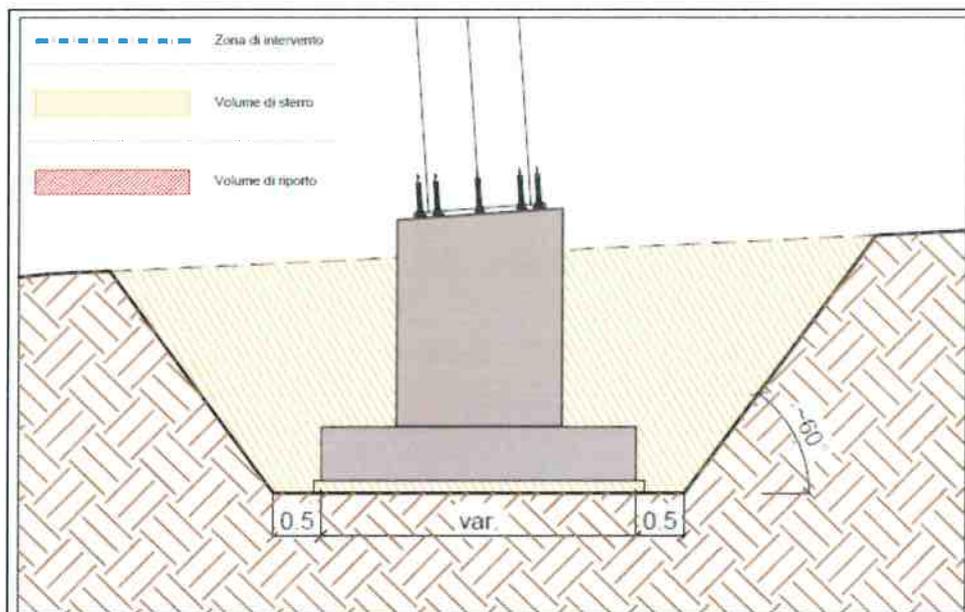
Sezione tipo scavo di linea (da elaborato 6.2.3).
